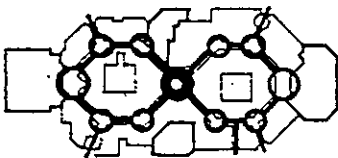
Macam-Macam Bentuk Bangunan untuk Mall (01)
